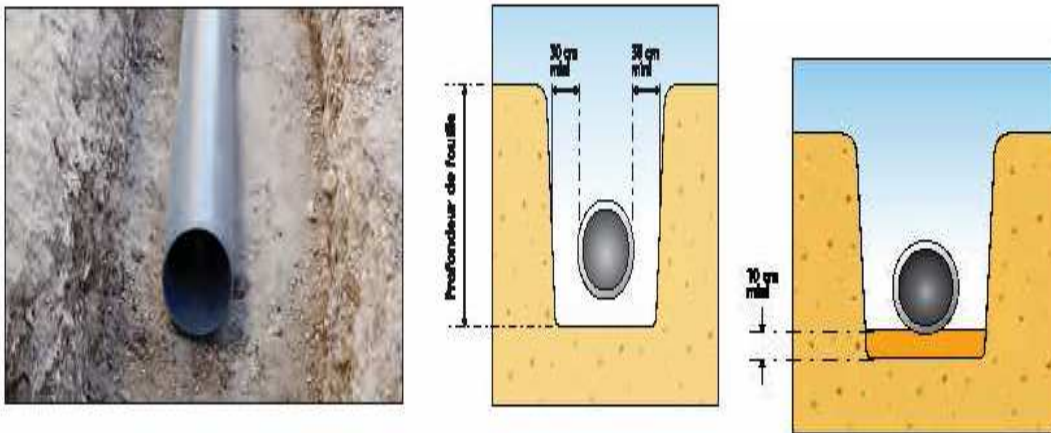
Coupe transversale d'une tranchée avec la mise en place de la conduite
